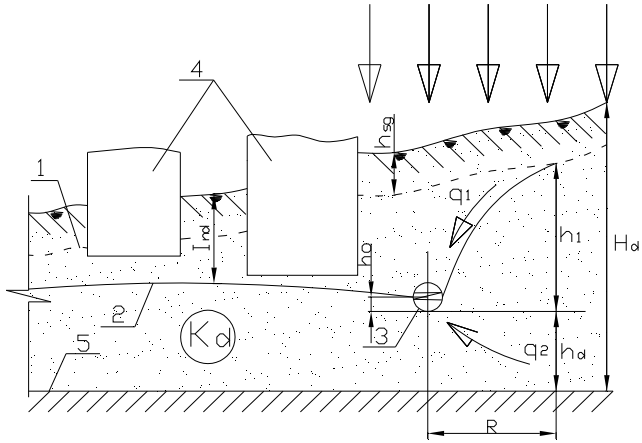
Схема до розрахунку головного горизонтального дренажу
